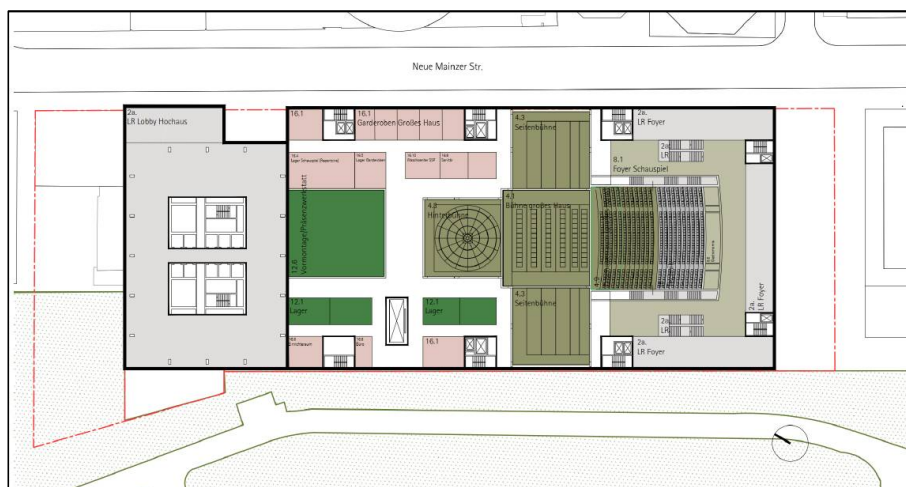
Grundriss Bühnenebene, 1. OG Variante 2b, Ausrichtung B
